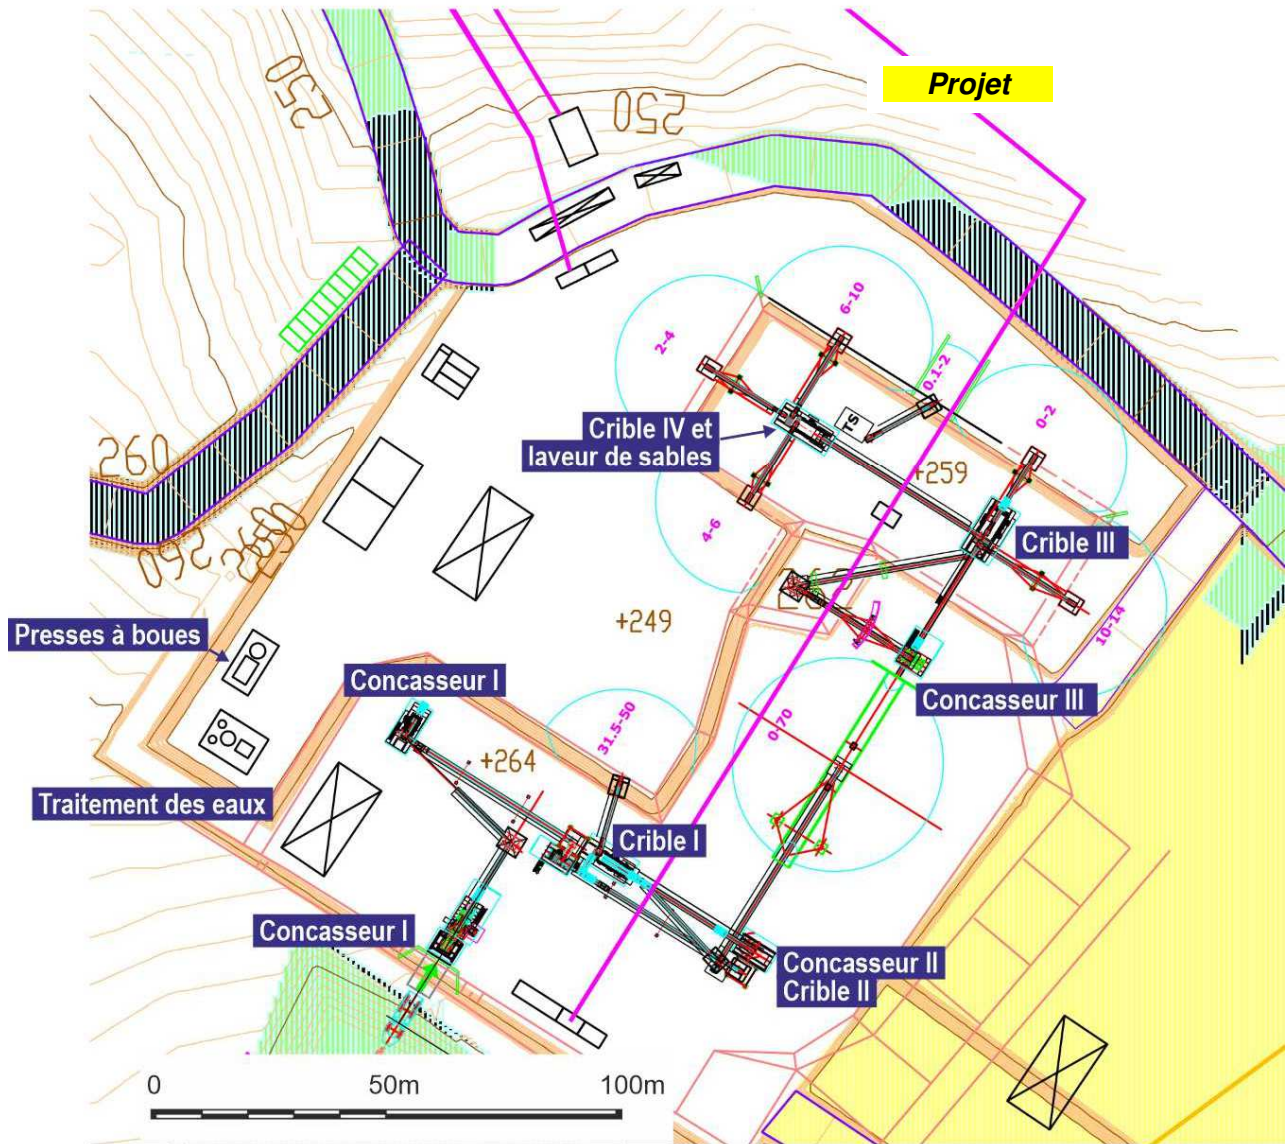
Plan de masse de l'installation future de lavage-concassage-criblage
